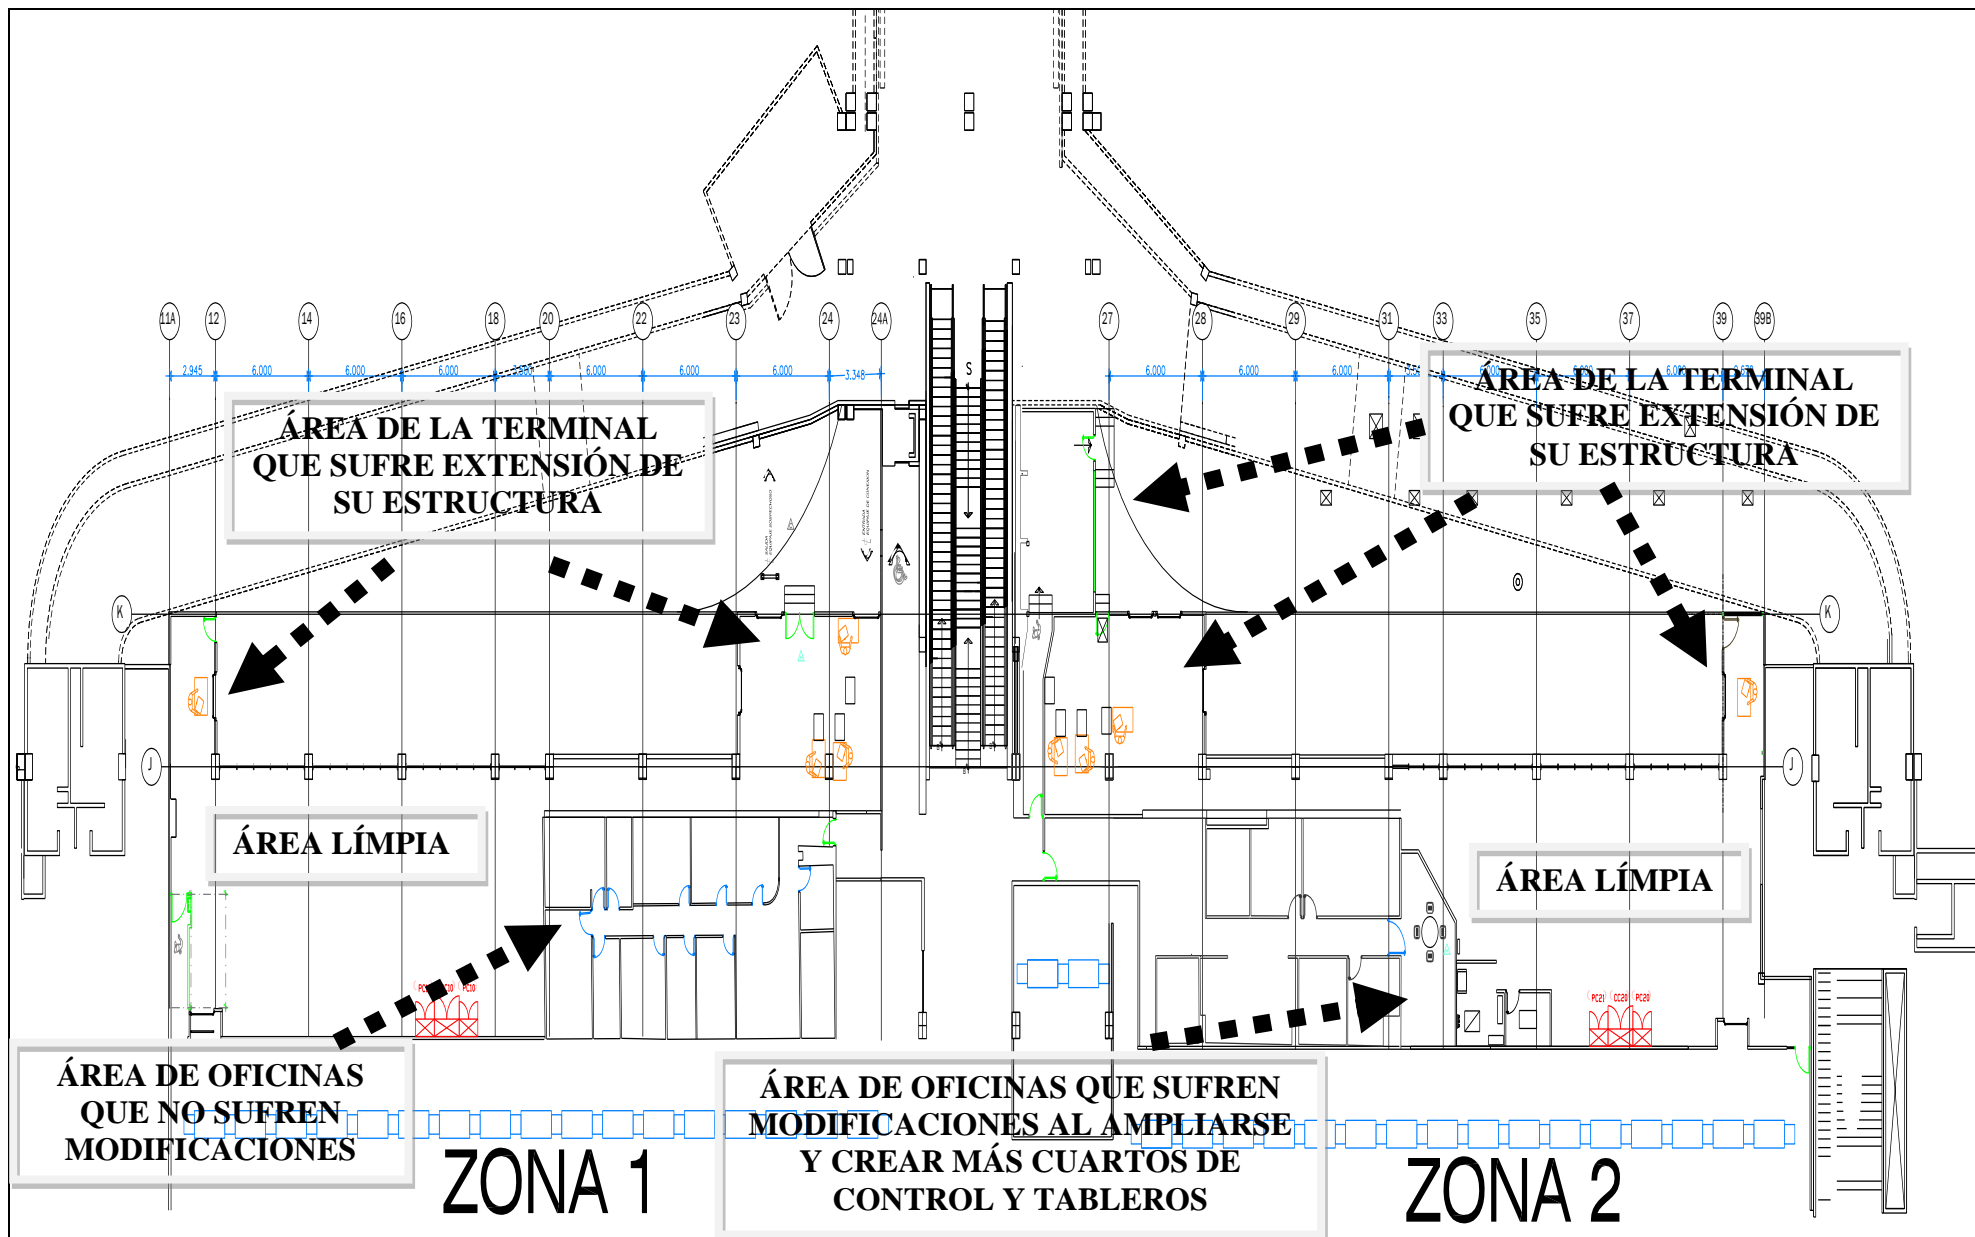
Plantas generales de remodelación en las zonas de la terminal A (Siemens, 2010)
